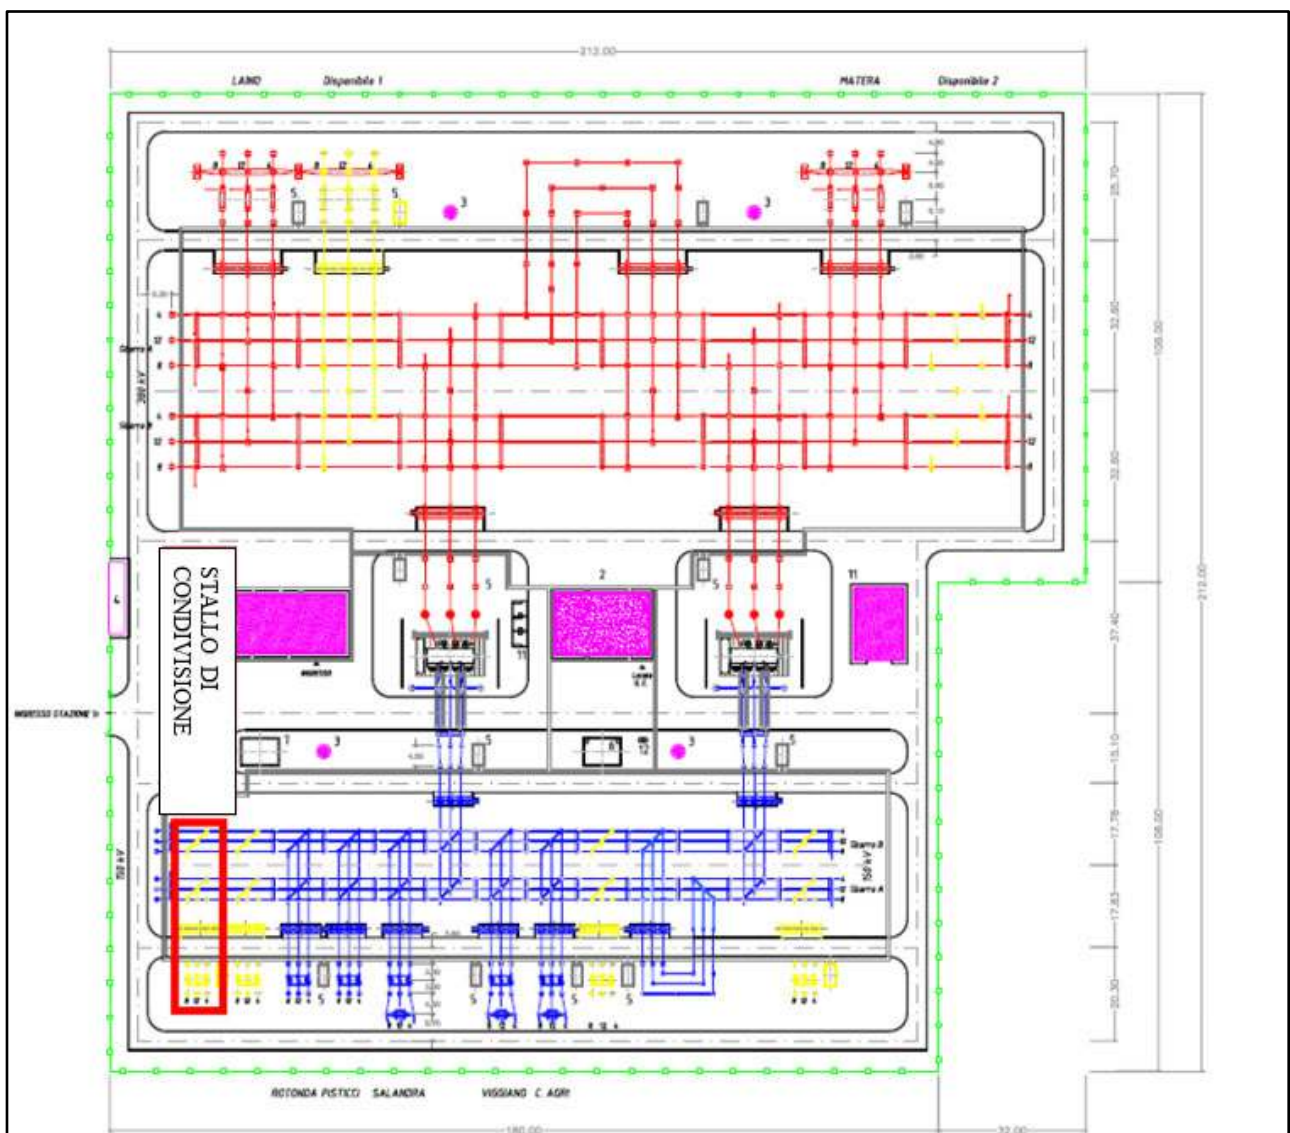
Planimetria della SE RTN a 380/150 kV con l'ubicazione dello stallò condiviso
